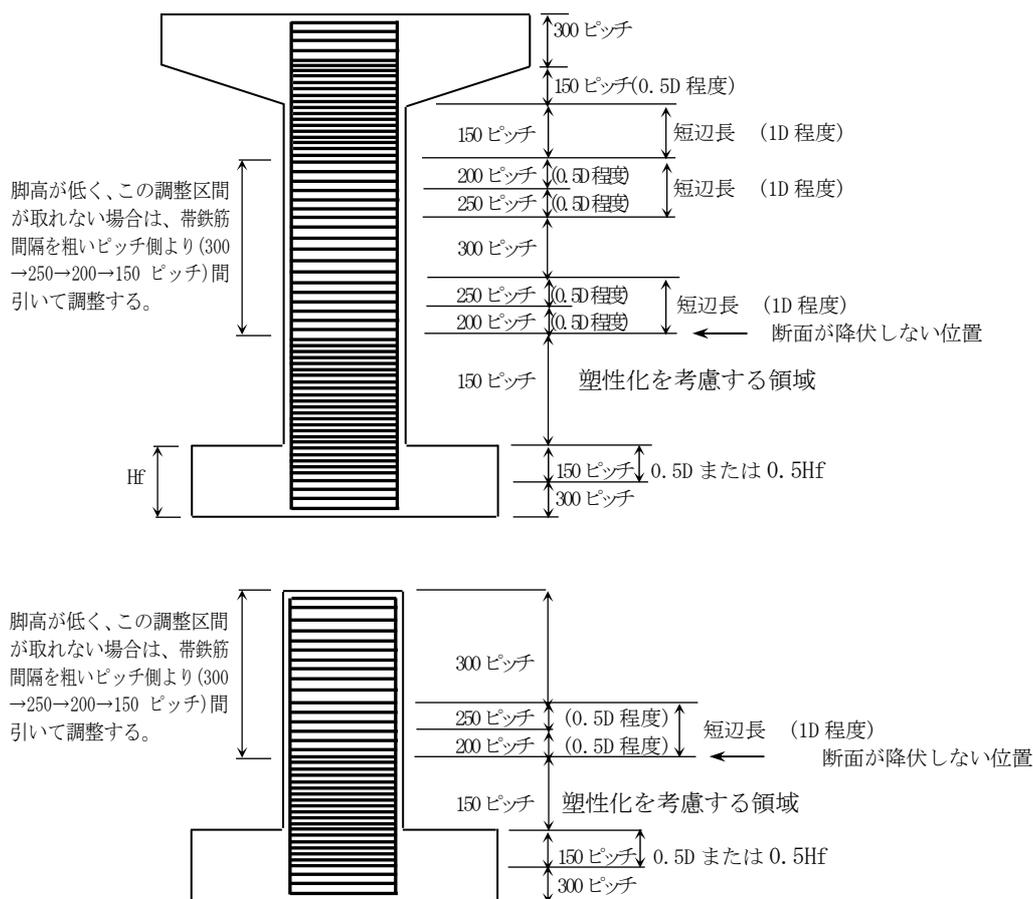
帯鉄筋摺り付け例 橋脚柱正面図
